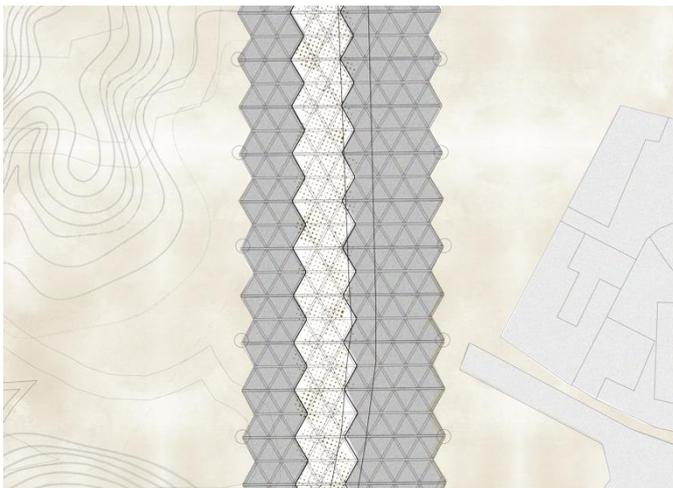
Zoom planta cubierta de sendero. Estructura de grilla triangular.
